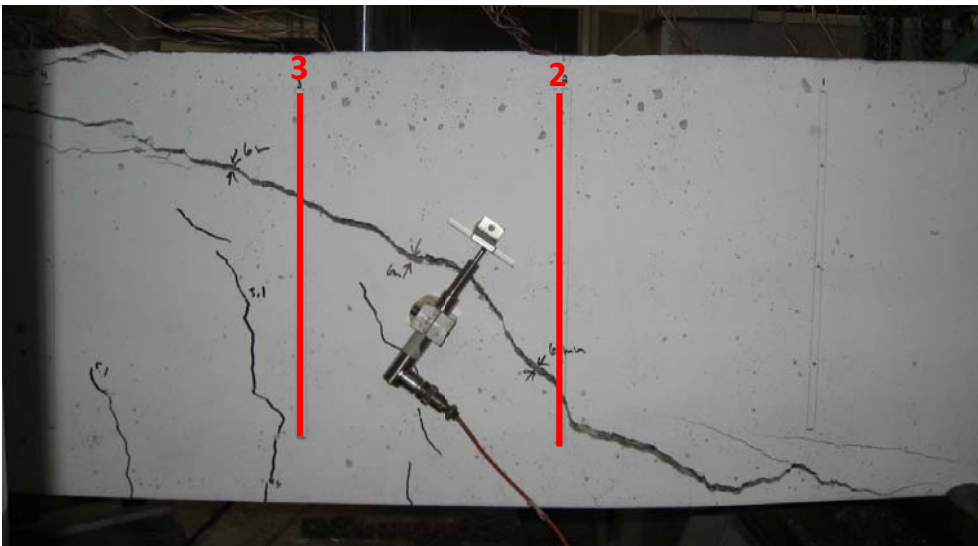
Position des barres de renforcement #2 et #3 de la dalle 2Ba, face nord
